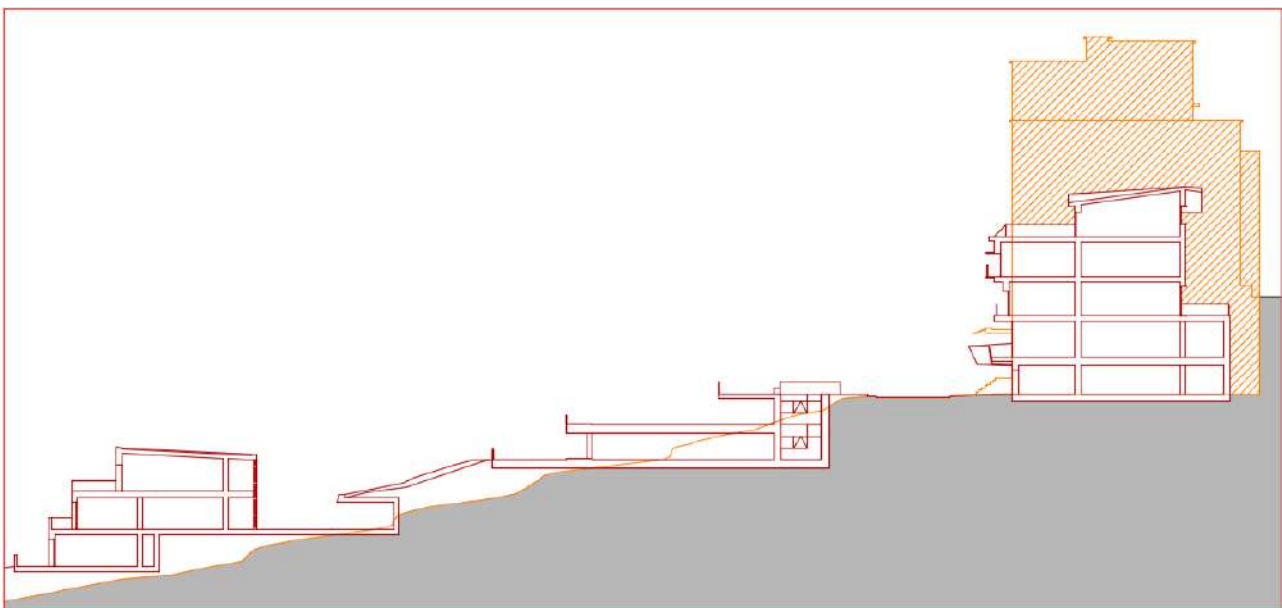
Sovrapposto con stato attuale (in arancio) - sezione longitudinale
